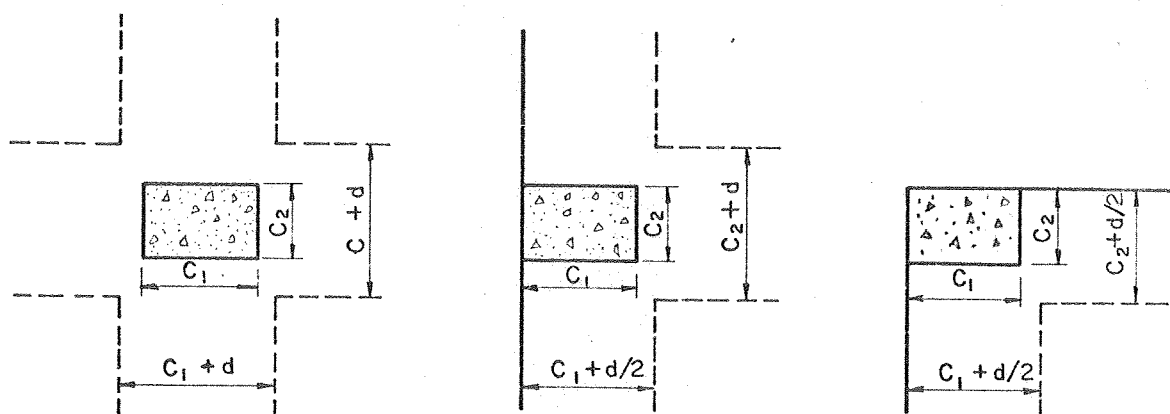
ANALOGIA DE VIGA, LARGURAS RECOMENDADAS - ACI-71
